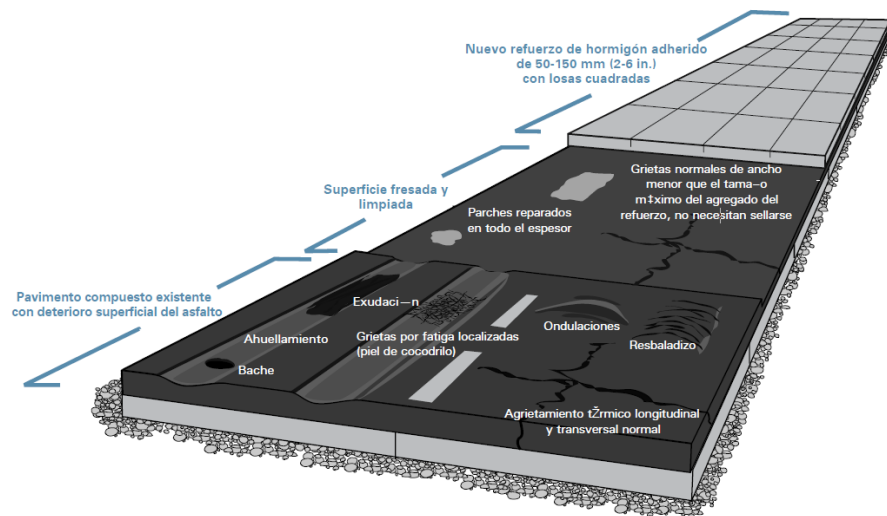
Whitetopping adherido a pavimentos semirrígidos en regulares o buenas condiciones con deterioro superficial del asfalto.
